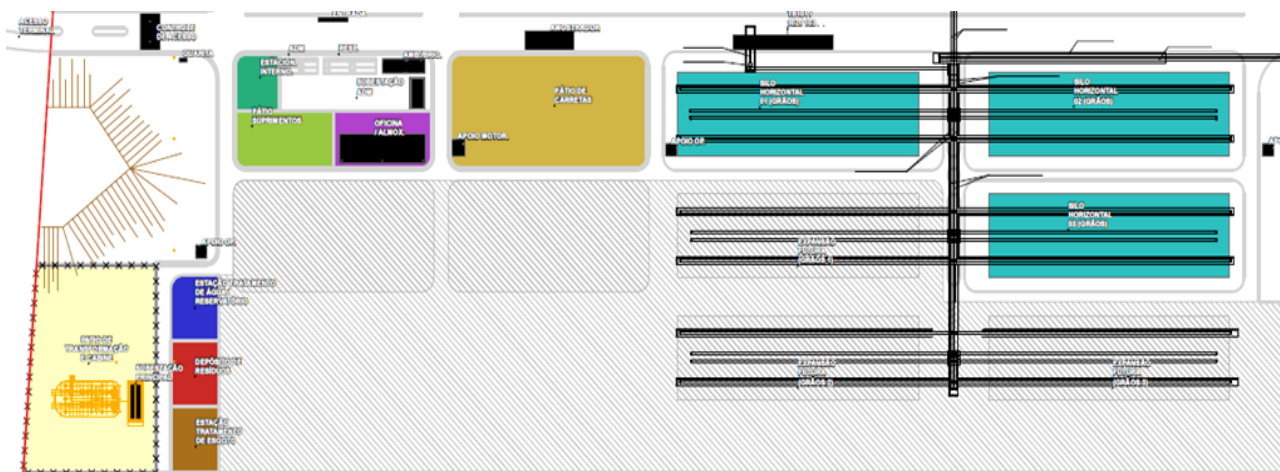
Estruturas Onshore do Terminal Portuário - área dos silos, pátio de carretas e setores associados. Fonte: LC Terminais Portuários.
